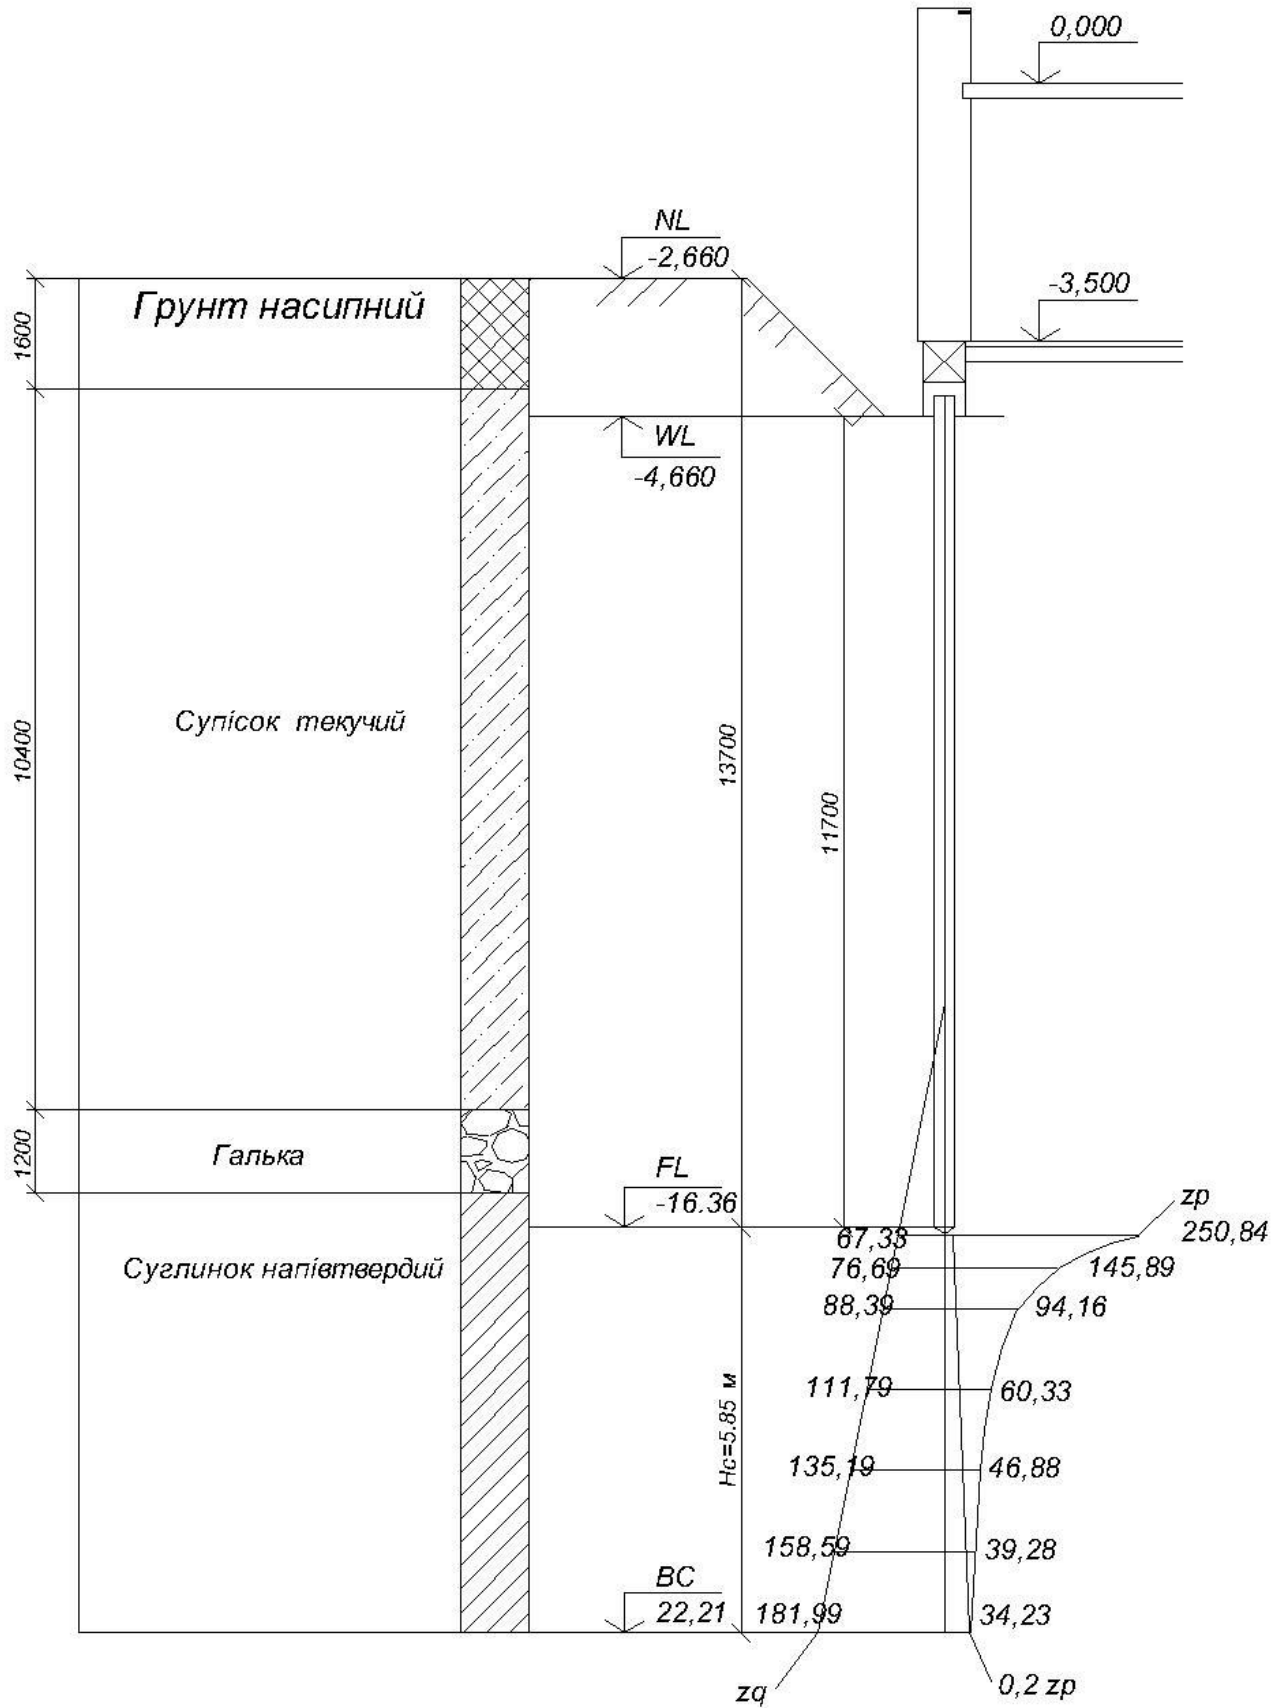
Схема до розрахунку просідання стрічкового пальового фундаменту по осі 14 на ділянці А-Г
